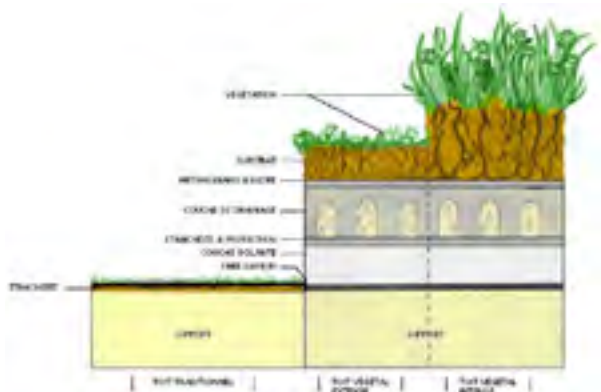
Coupe d'un toit végétal intensif et extensif (source : <http://www.apte-asso.org/a-voir-ou-telecharger/eco-construction/toiture-vegetale>)
